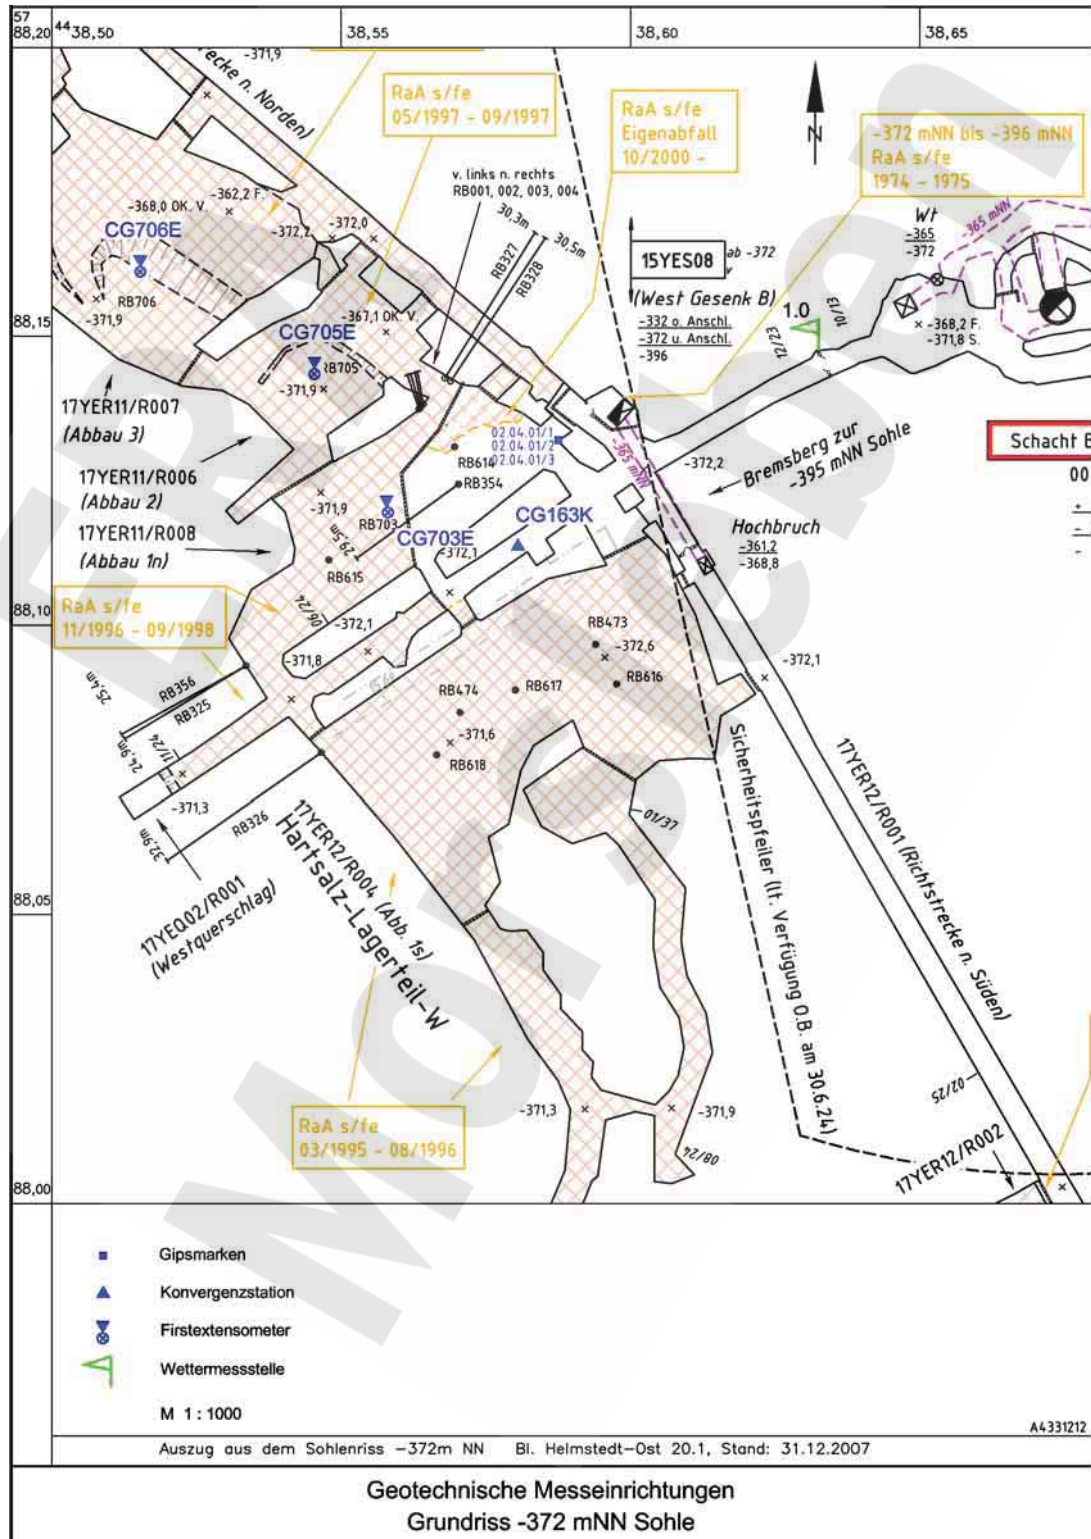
Geotechnische Messeinrichtungen Grundriss -372 mNN Sohle
